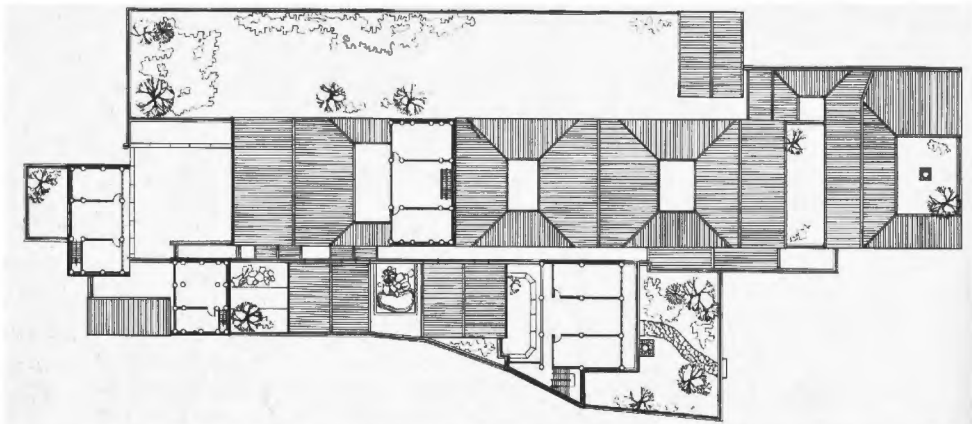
Planta casa con patio en Soochow, al sur del río Yang-tse.
